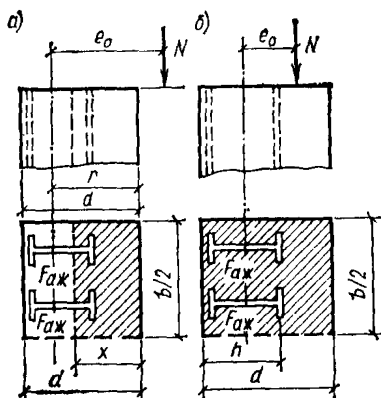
Схема расчета железобетонной крепи с жесткой арматурой
